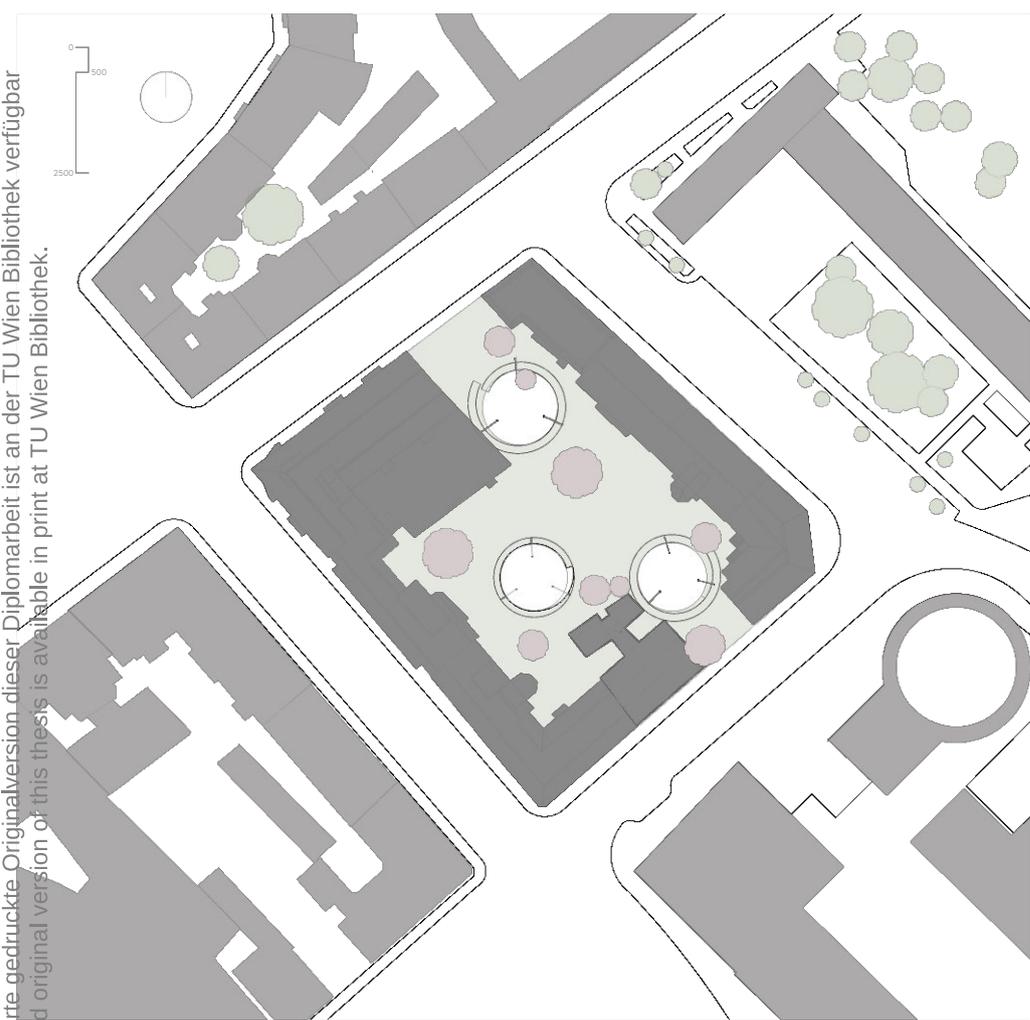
Grundriss Konstruktion | Stützen
